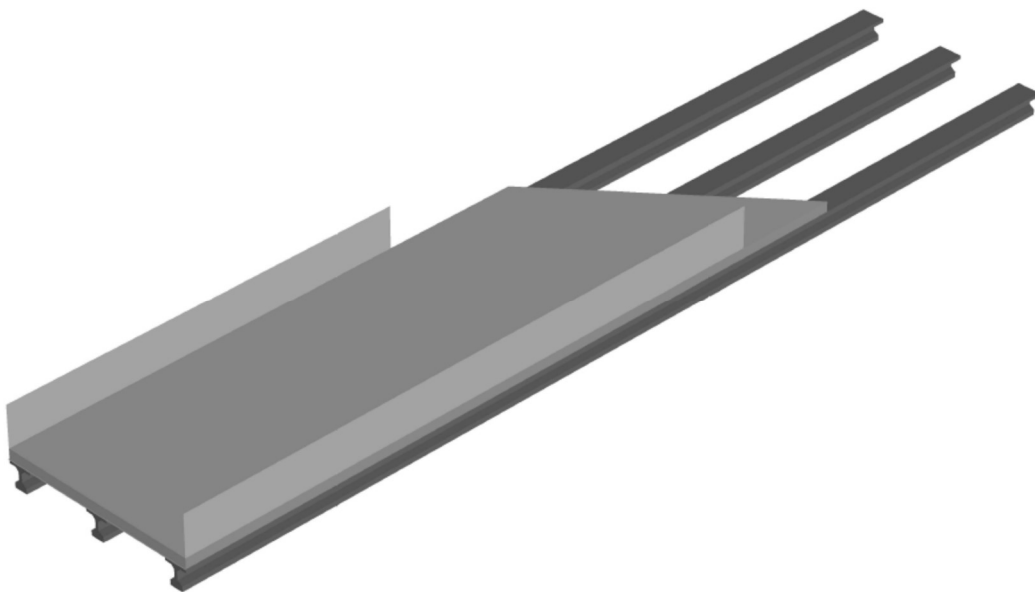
Vista oblicua vano simple de hormigón pretensado
